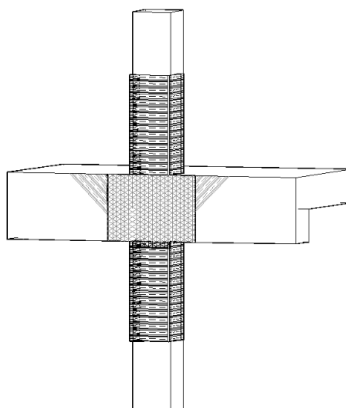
Schema di applicazione del tessuto uniassiale alle estremità di un pilastro d'angolo. (Fonte ReLuis)
